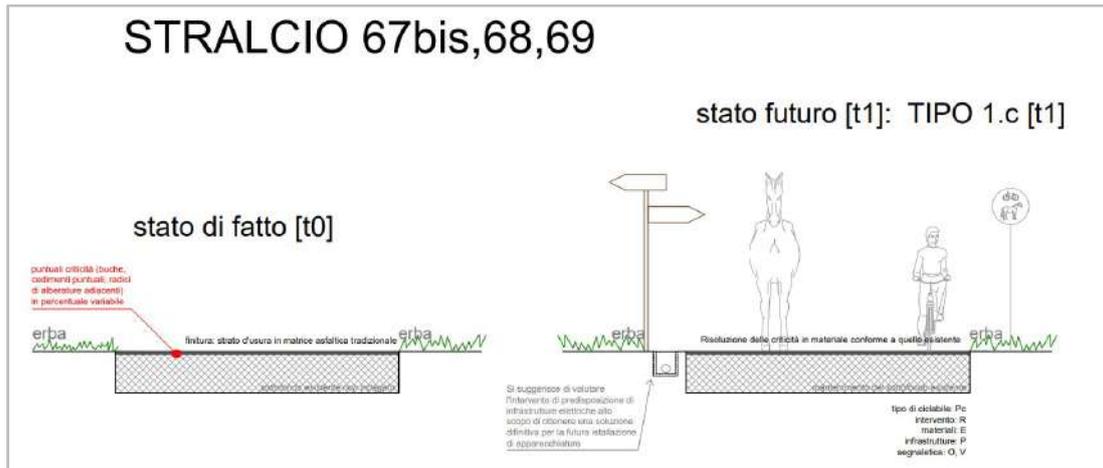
Stato attuale, Stato futuro e fondo di progetto di tipo 1.c
